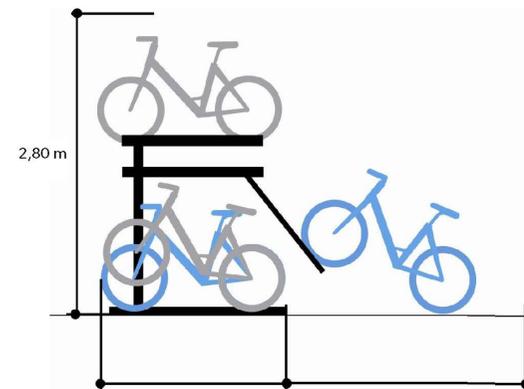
Rangement sur deux niveaux allié à une disposition resserrée
